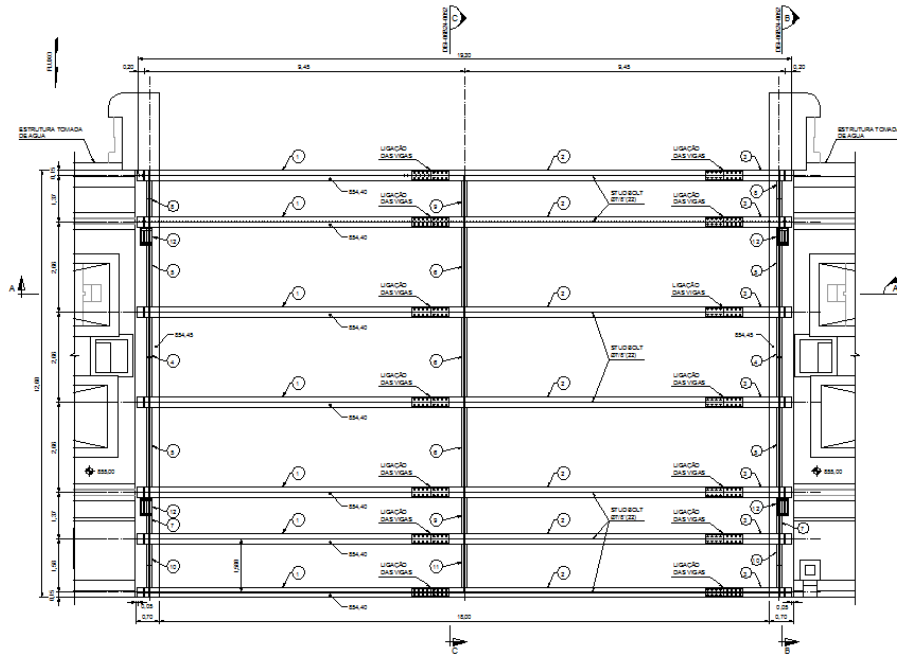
Puente entre unidades – Planta (Intertechne, 2015)
